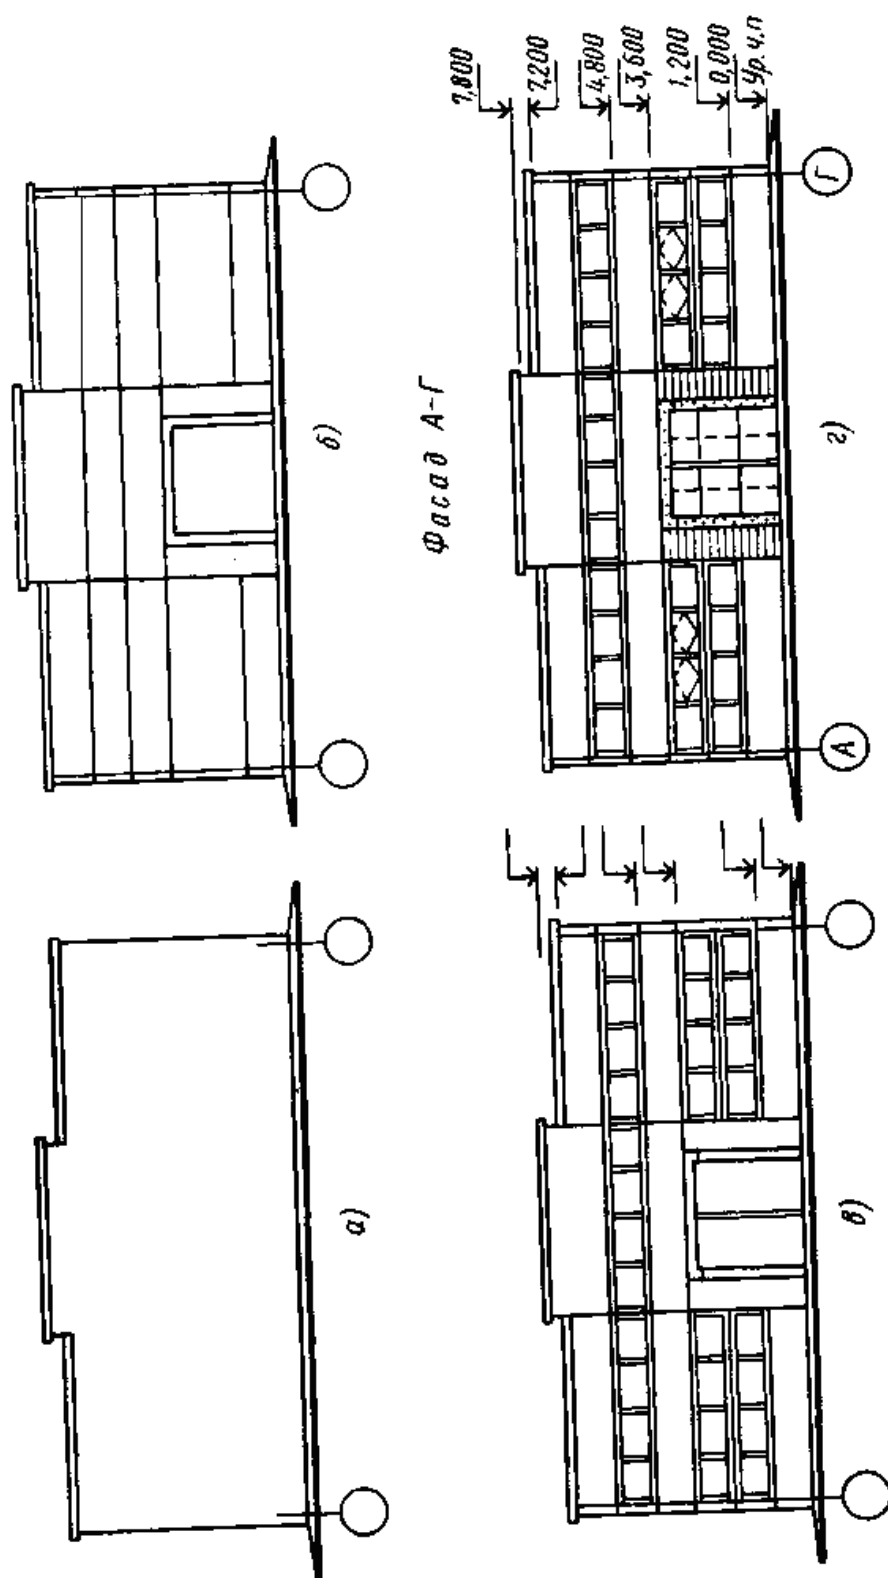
Последовательность (а..г) вычерчивания фасада здания
